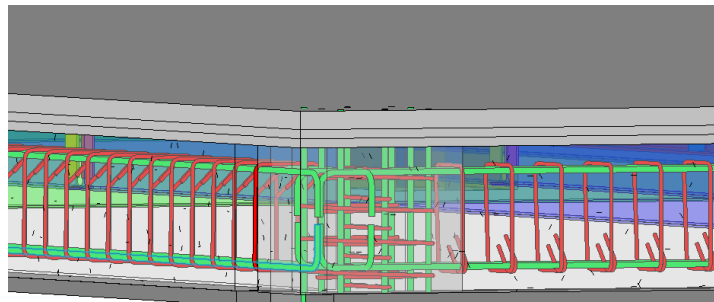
Modelado del acero de refuerzo en las columnas y vigas
